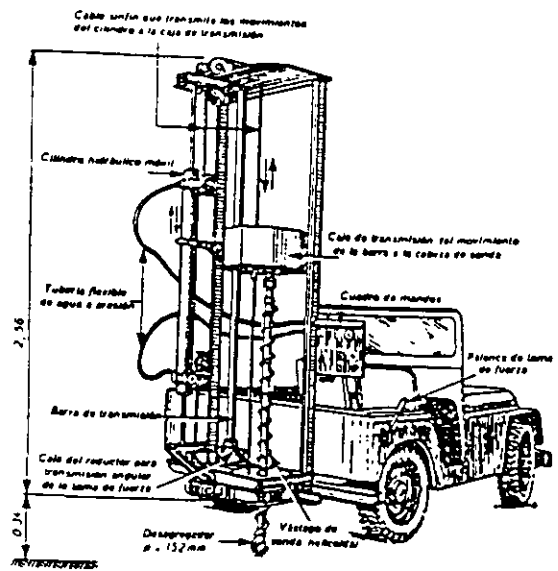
Sonda ligera móvil (modelo "Drilling B.27")
